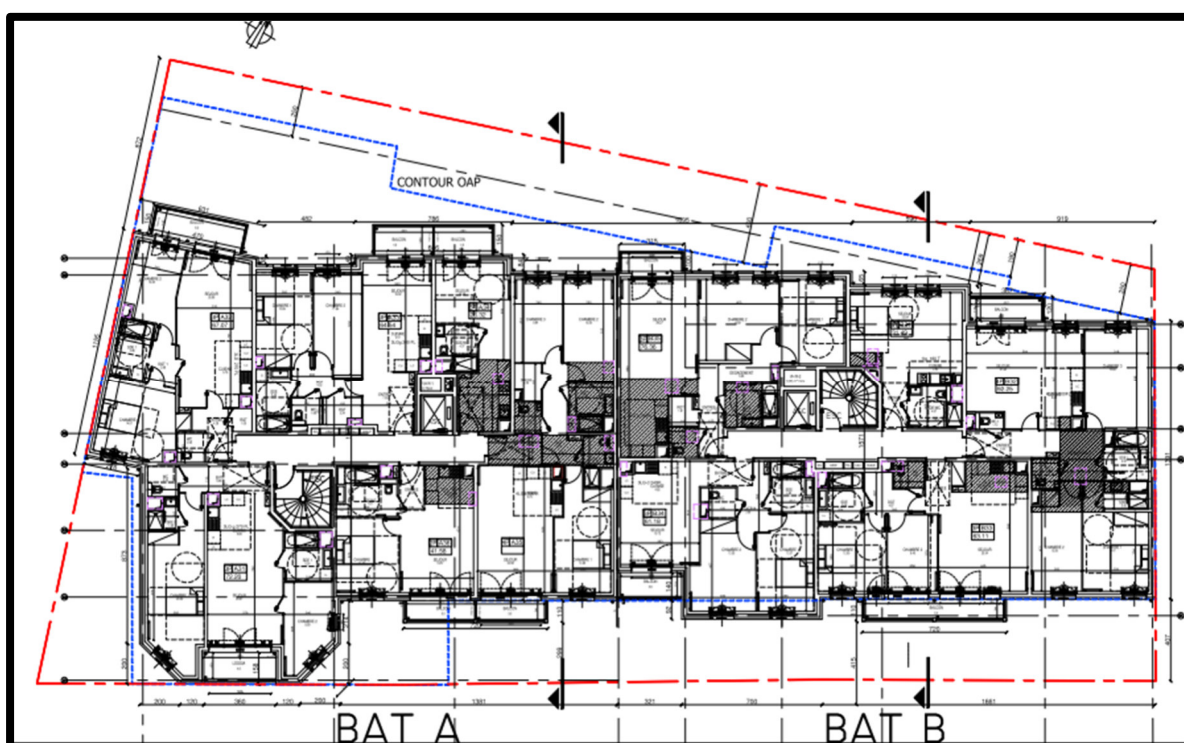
Planta Piso tipo do edifício de estudo (fase projeto)
